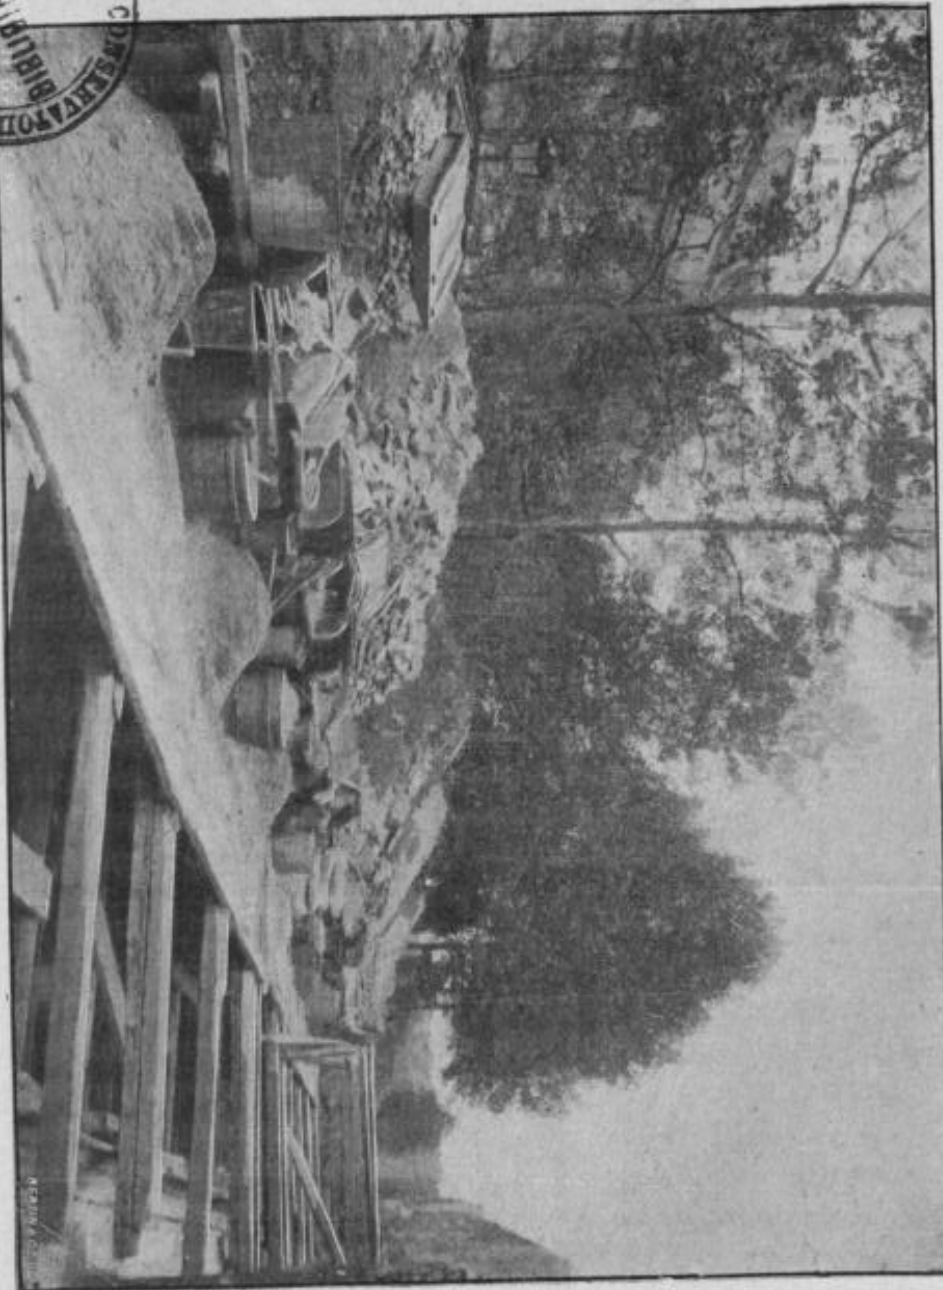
Construction d'un nouvel égout collecteur sous le boulevard de Clichy :
